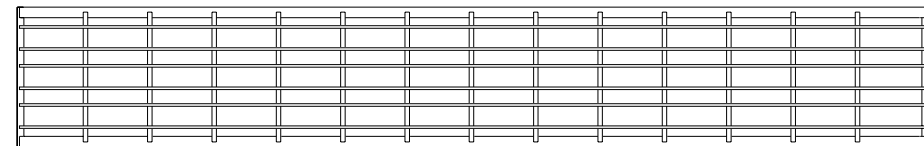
Lamelle Typ 2 - obere Leistenlage
